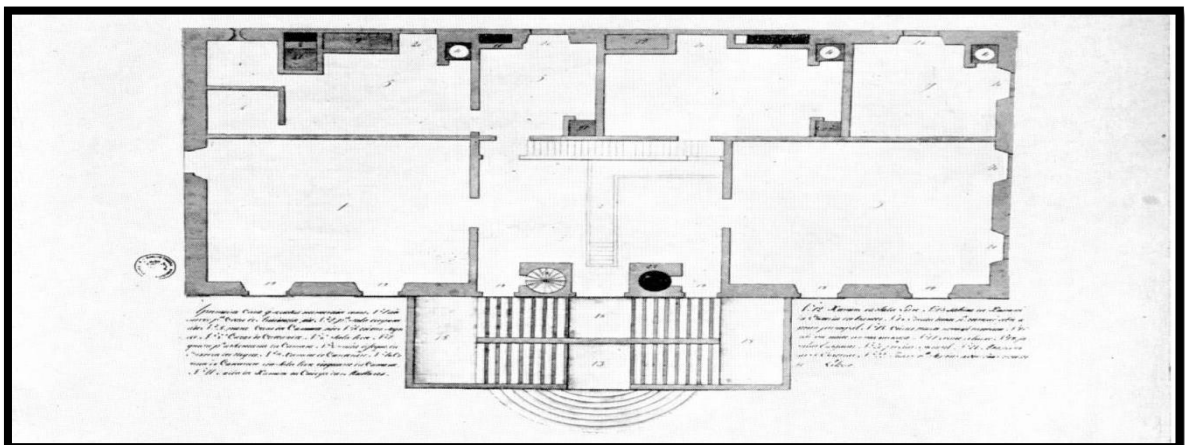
Planta baixa da antiga Casa de Câmara e Cadeia de Mariana.
